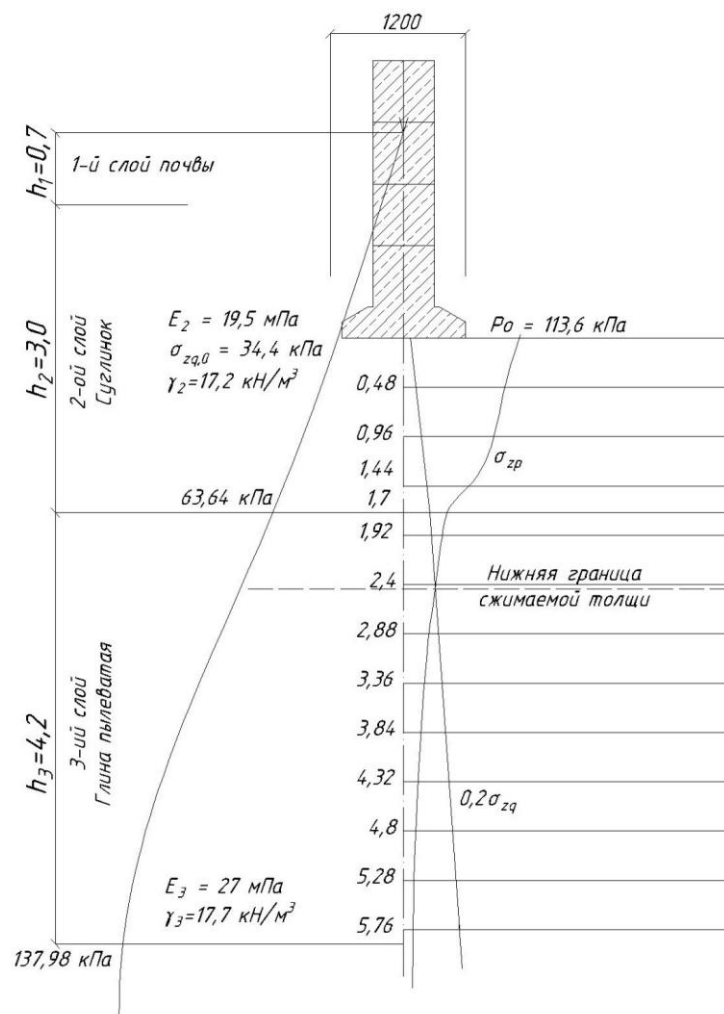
Расчетная схема осадки ленточного фундамента первого типа
